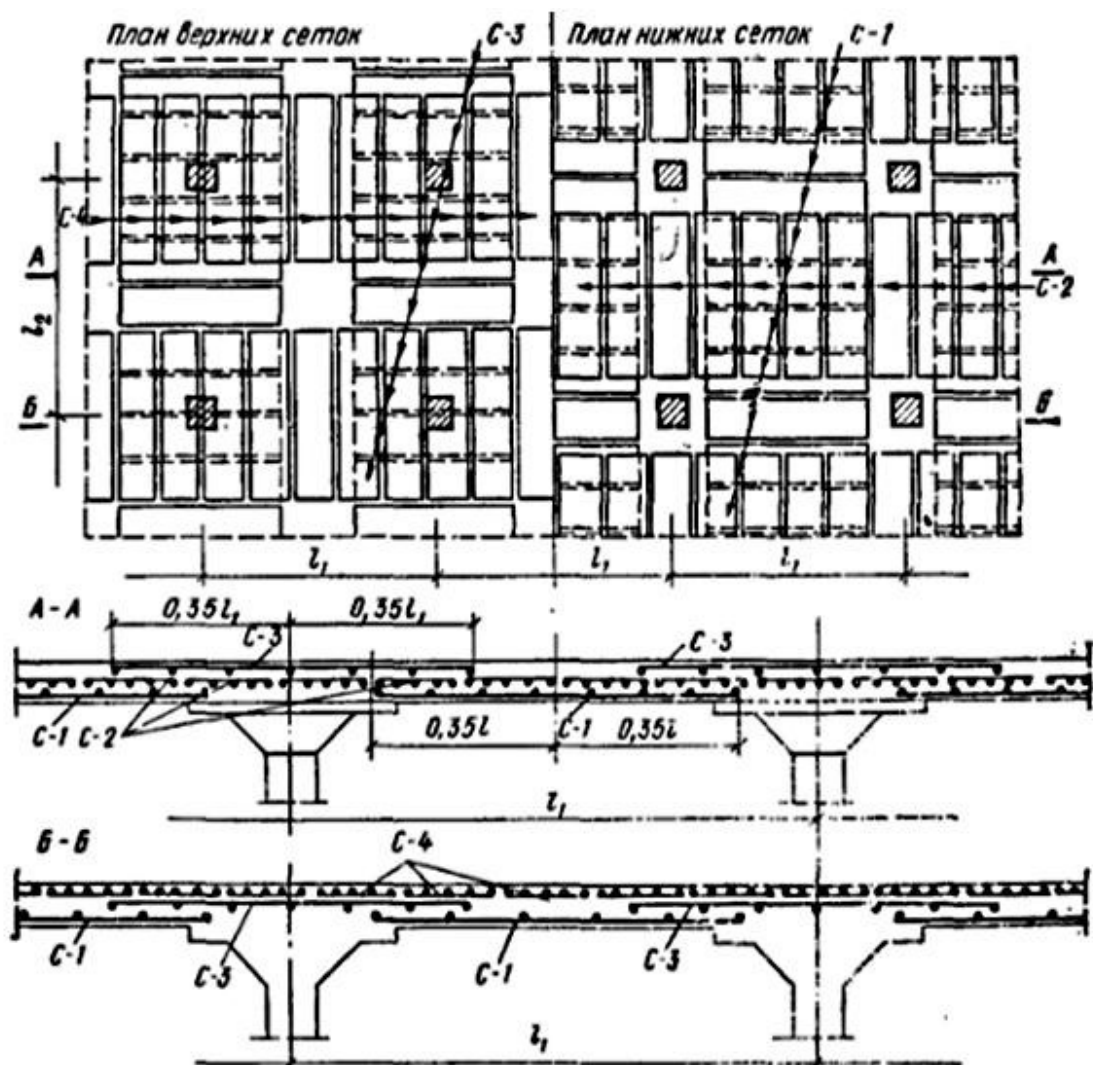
Армирование безбалочного перекрытия узкими сетками
